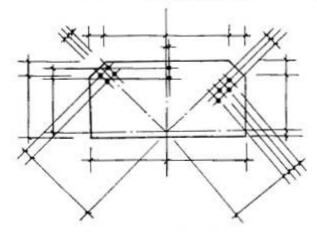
非焊接节点板尺寸的标注方法
